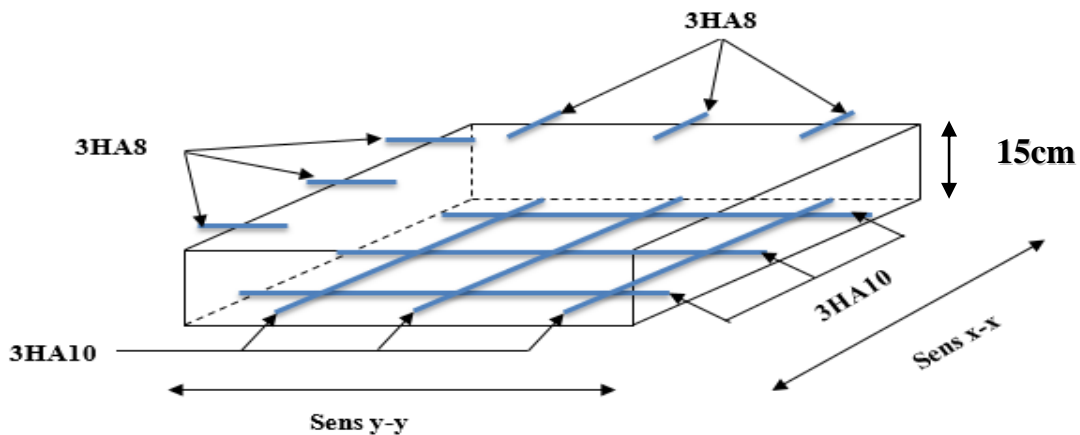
Schéma de Ferrailage de la dalle pleine de la locale machinerie.
